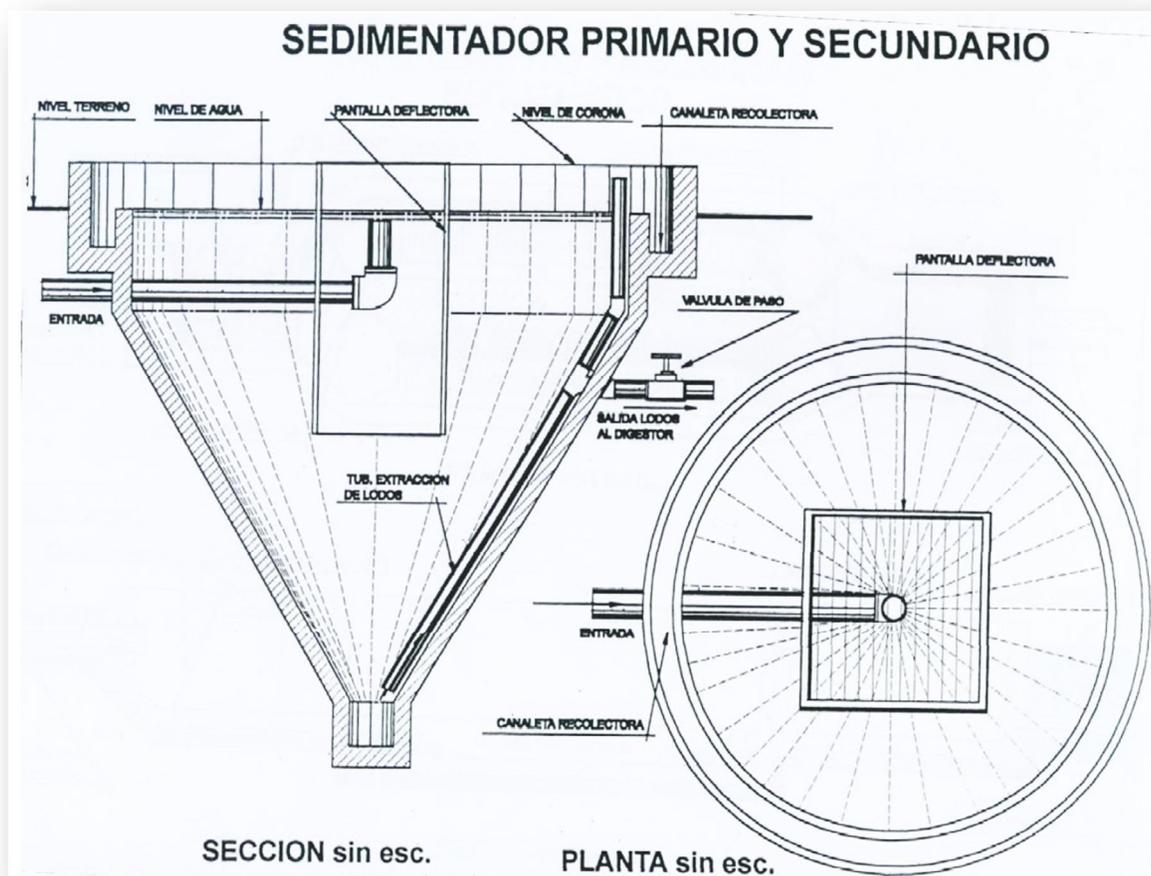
Esquema de un tanque de sedimentación simple. (Planta y Corte).
